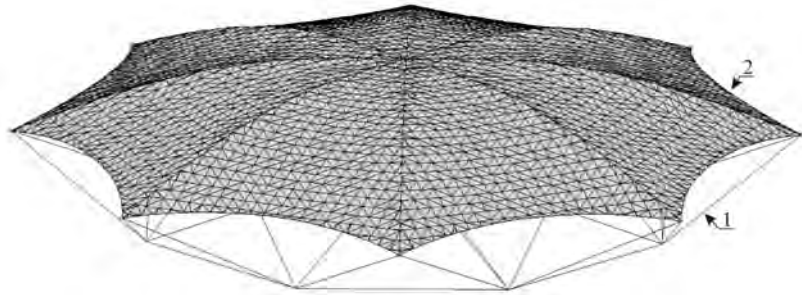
Предварительно напряженная конструкция покрытия: 1 — нижний пояс, состоящий из стальных тросов и стоек; 2 — гибкий верхний пояс, покрытый полимерной мембраной
